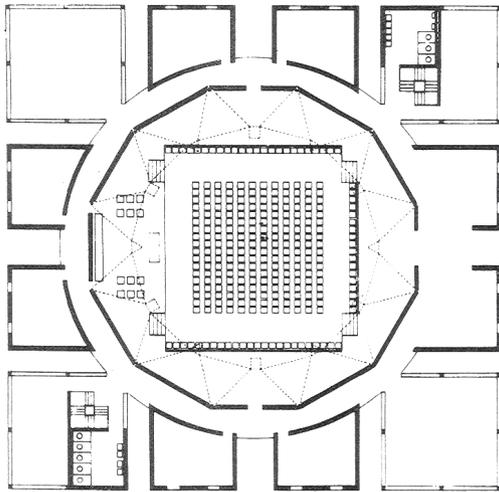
Primeira Igreja Unitária e Escola. Planta (janeiro, 1961).
